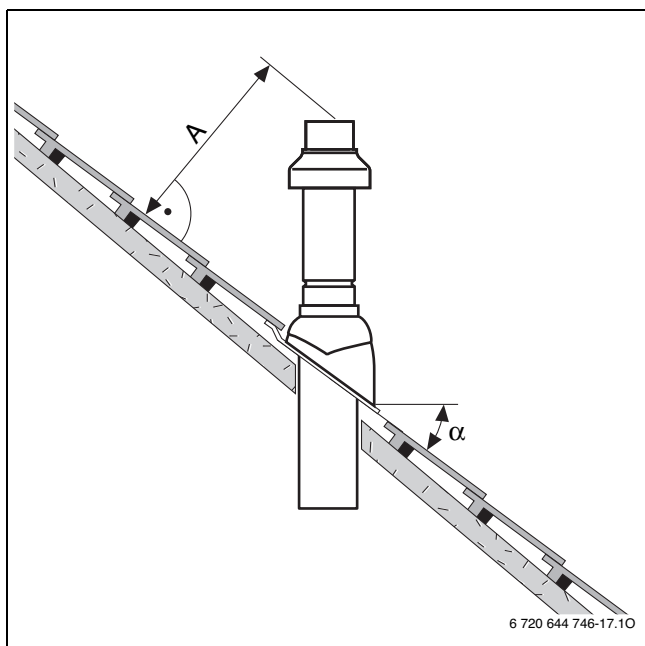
Passaggio attraverso il tetto con tetto inclinato
